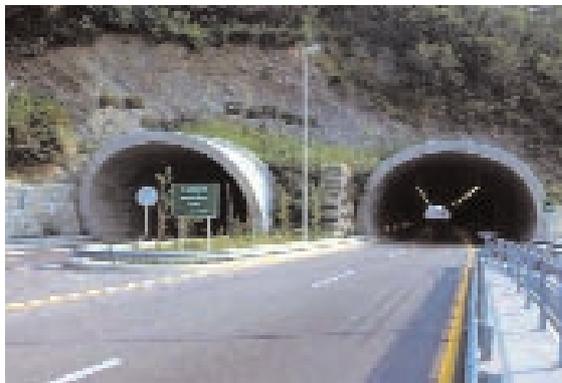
Rivegetazione rilevati e crib-wall, Galleria di Servola. Grande viabilità triestina (TS). Foto G. Sauli - 1988
